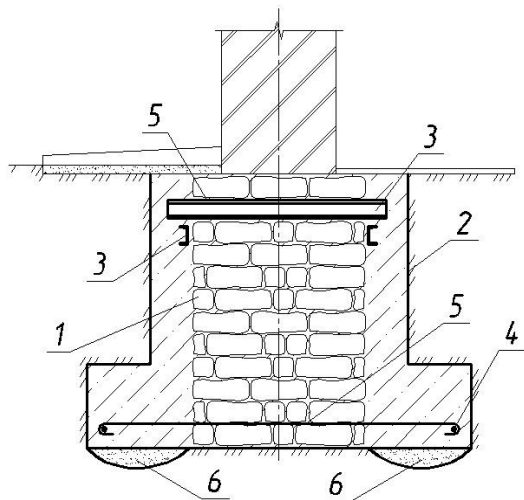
Посилення опорної площі улаштуванням приливів з бетону:
